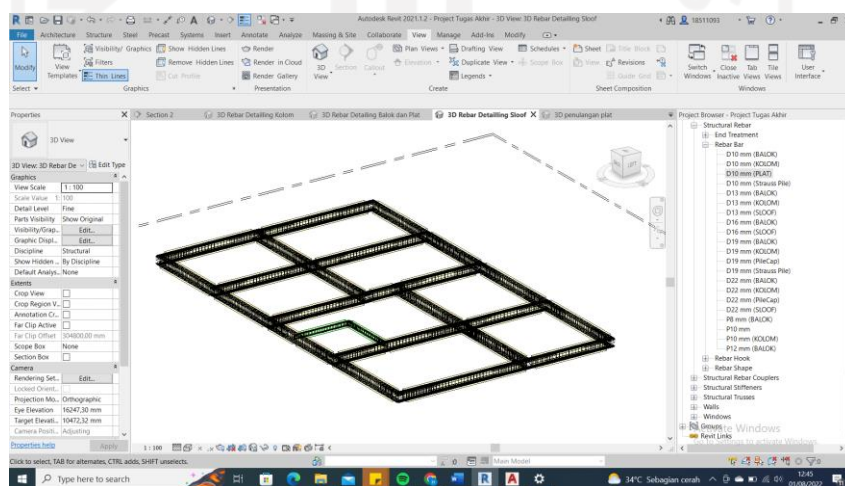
22 Tampilan Lokasi Potongan untuk Membuat Sloof dan Balok
